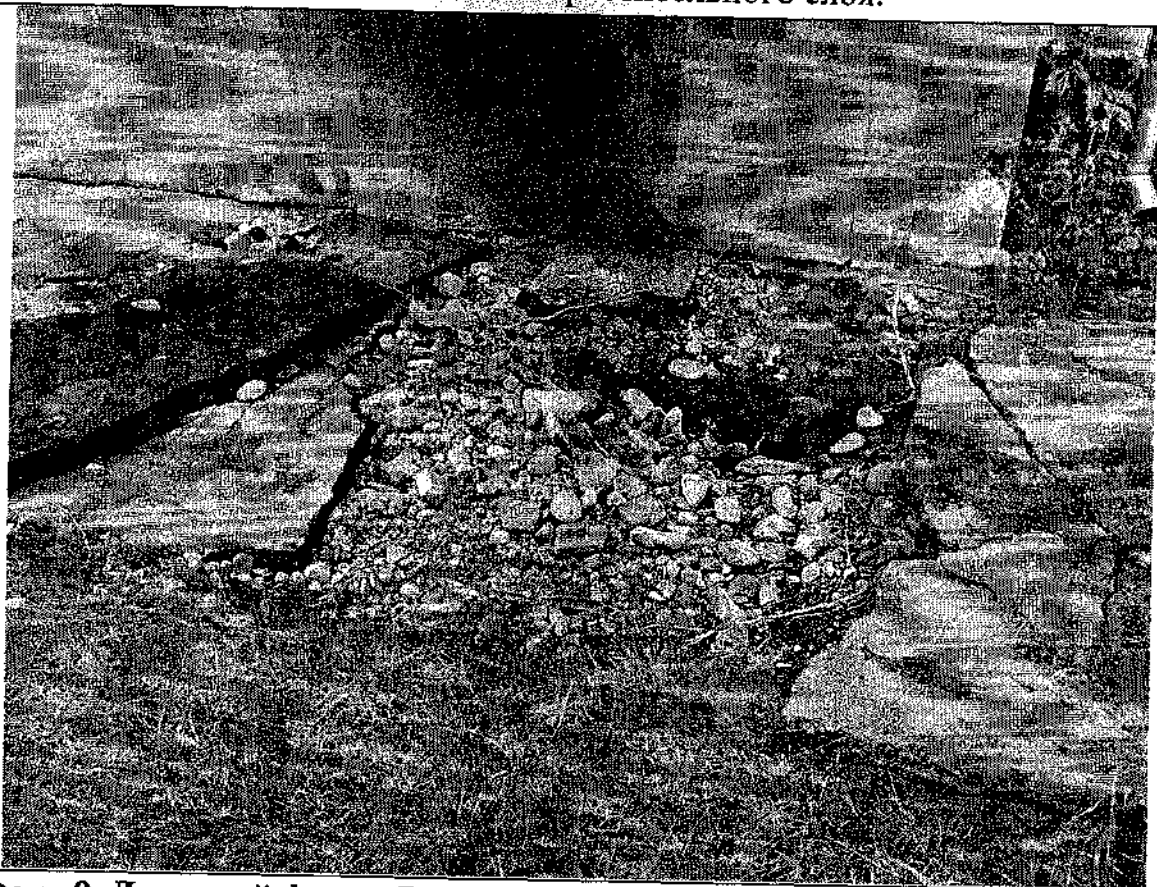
Дворовой фасад. Разрушение отмостки со стороны 3-го подъезда.
